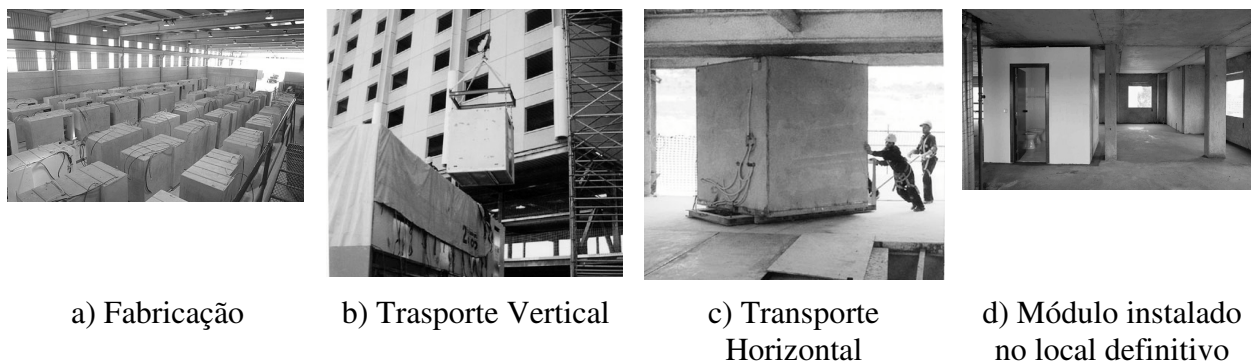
Fabricação e instalação de banheiros pré-fabricados
